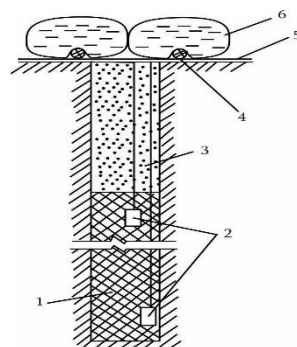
Размещение герметичной оболочки с водой на поверхности взрываемого блока вблизи устья скважины: 1 – заряд скважины, 2 - зарядный патрон, 3 - наполнитель из глины, 4 – дополнительный заряд взрывчатки, 5 - пакеты с взрывчаткой, 6 - вода в полиэтиленовом пакете
